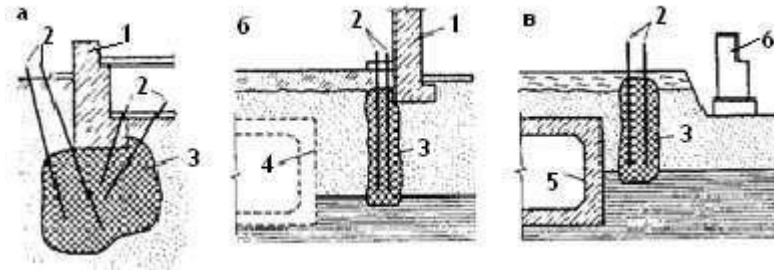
Схема закріплення методом силікатизації: а – основ фундаментів; б – захист фундаментів будівель при будівництві підземних споруд; в – при зведенні будівель: 1 – фундамент; 2 – ін'єктори; 3 – зони закріплення; 4 – підземна споруда, що будується; 5 – існуючий тунель; 6 – будівля, що будується.
